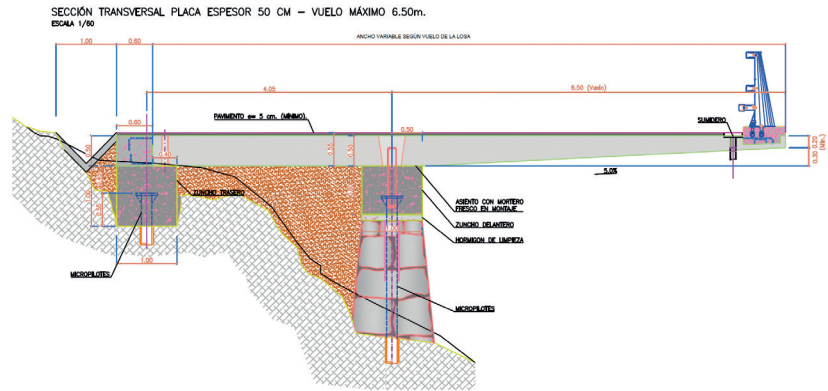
Sección tipo de voladizo para vuelo máximo de 6,5m
